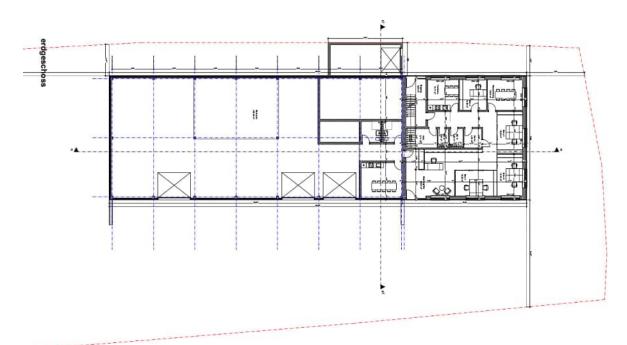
Auszug der Grundrissplanung des Erdgeschosses
